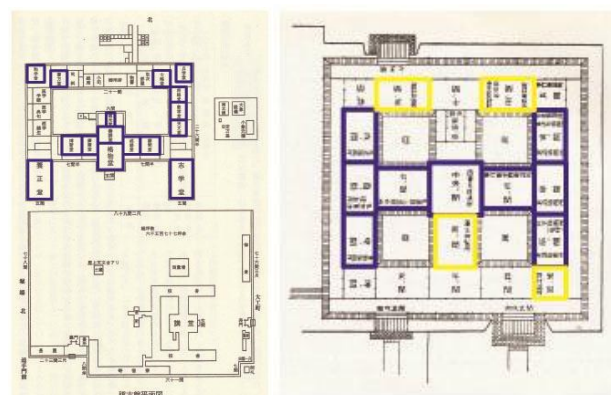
弘前藩稽古館平面図 Fig5.仙台藩養賢堂平面図
